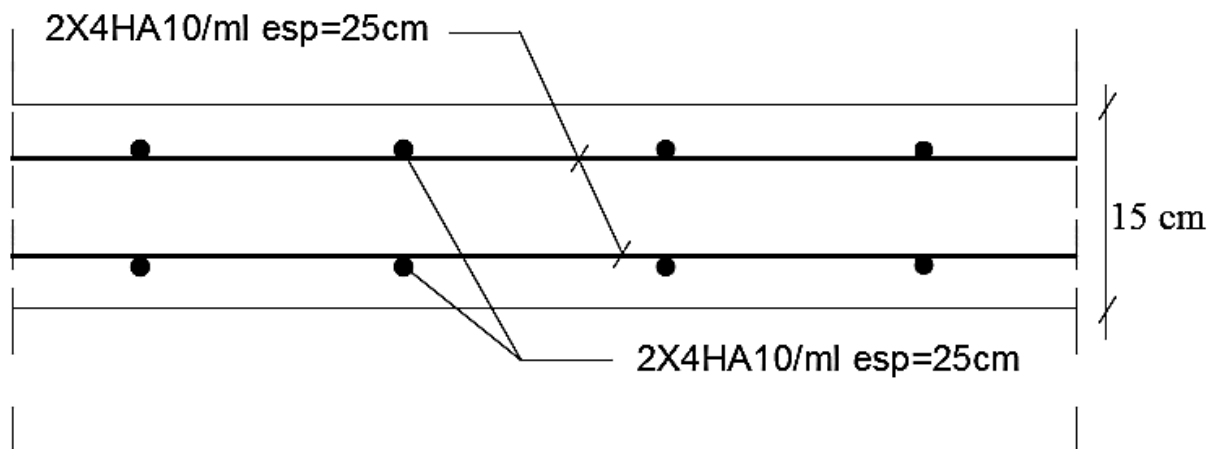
Ferrailage de la dalle pleine de la salle machine
